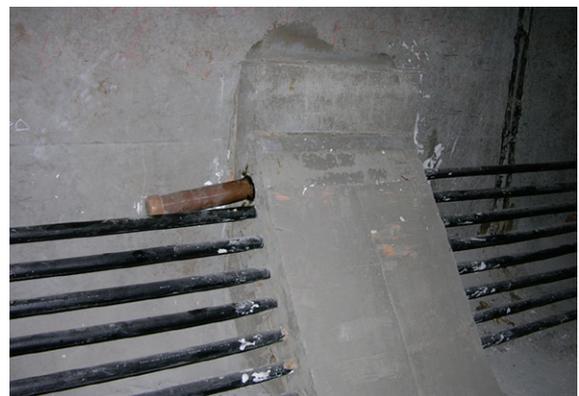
REFORÇO NA FACE INFERIOR DAS ADUELAS: PROJETO DE MARIO VILA VERDE
